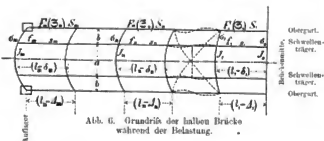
Grundriss der halben Brücke während der Belastung.
